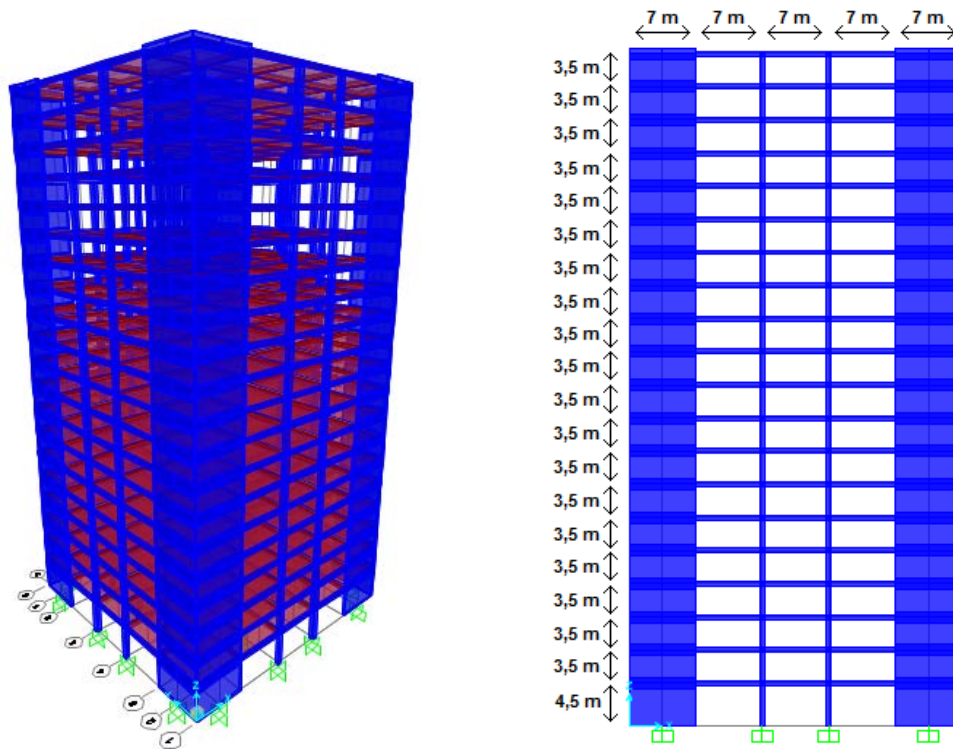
Geometría 3D y elevación exterior del edificio en base a 2 muros exteriores
